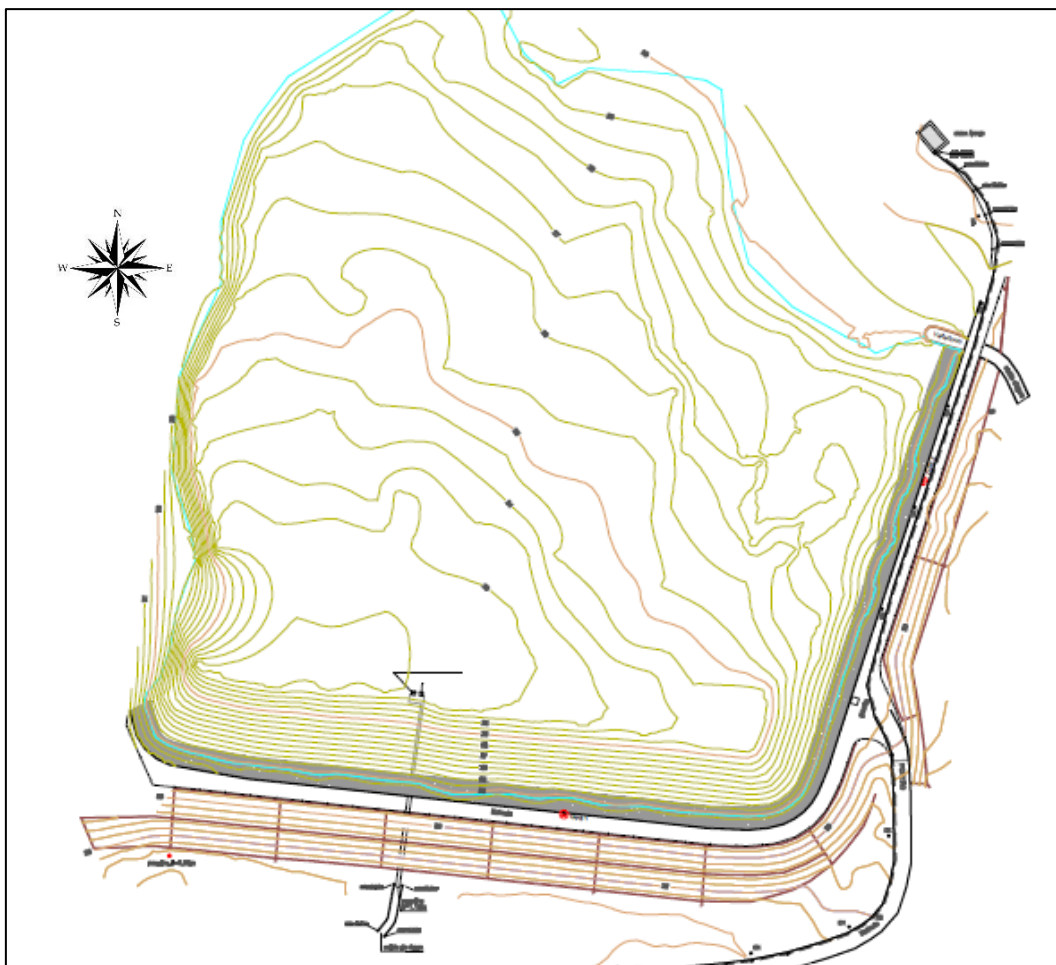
Planta baixa de levantamento topográfico da Barragem X (adaptado de Viana et al., 2015).
